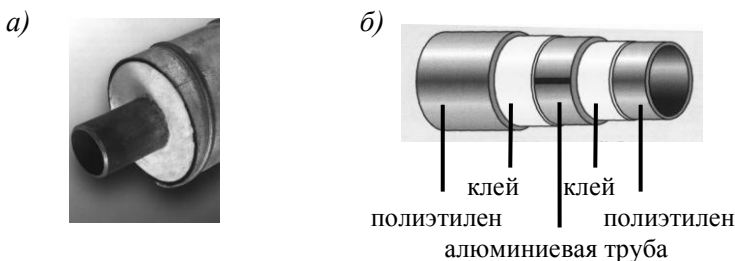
Защитные покрытия металлоконструкций: а) стальная труба; б) металлопластмассовая труба
